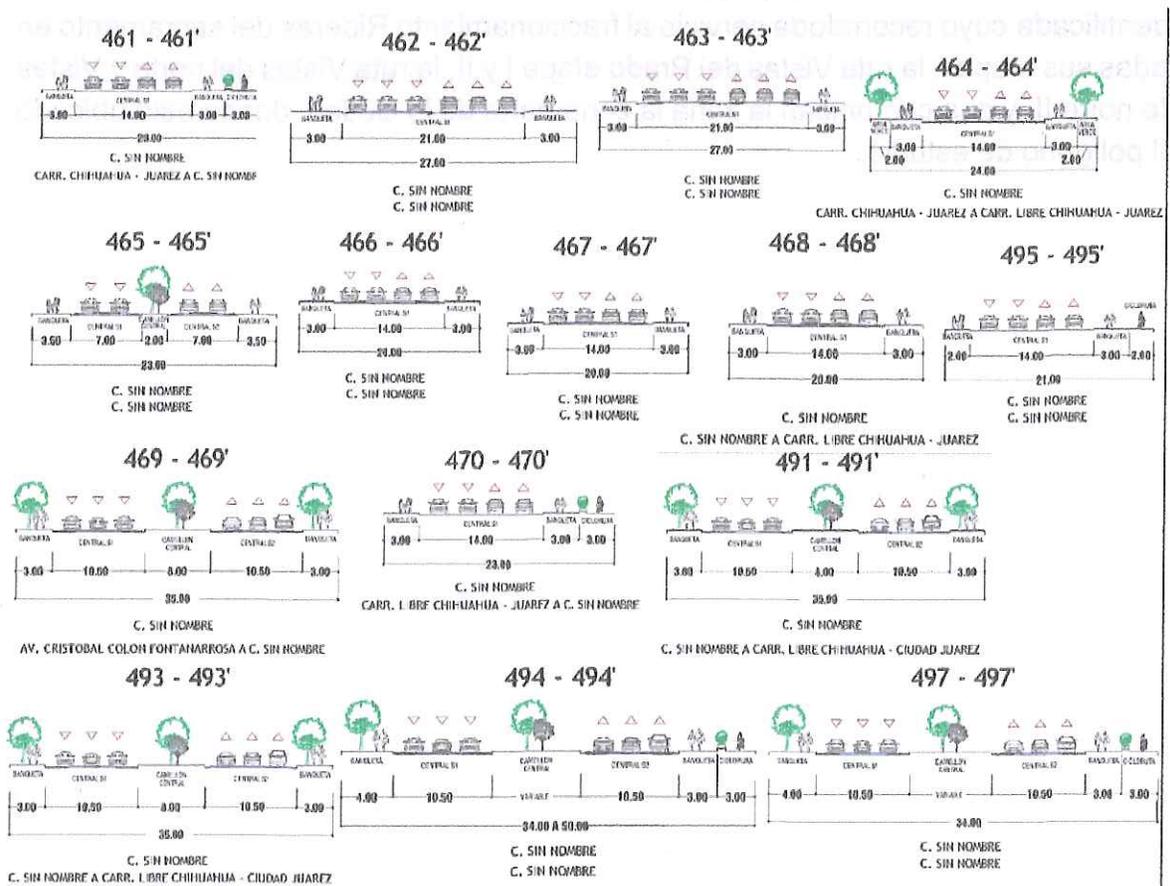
D-05. Secciones Viales Existentes PDU 2040.
